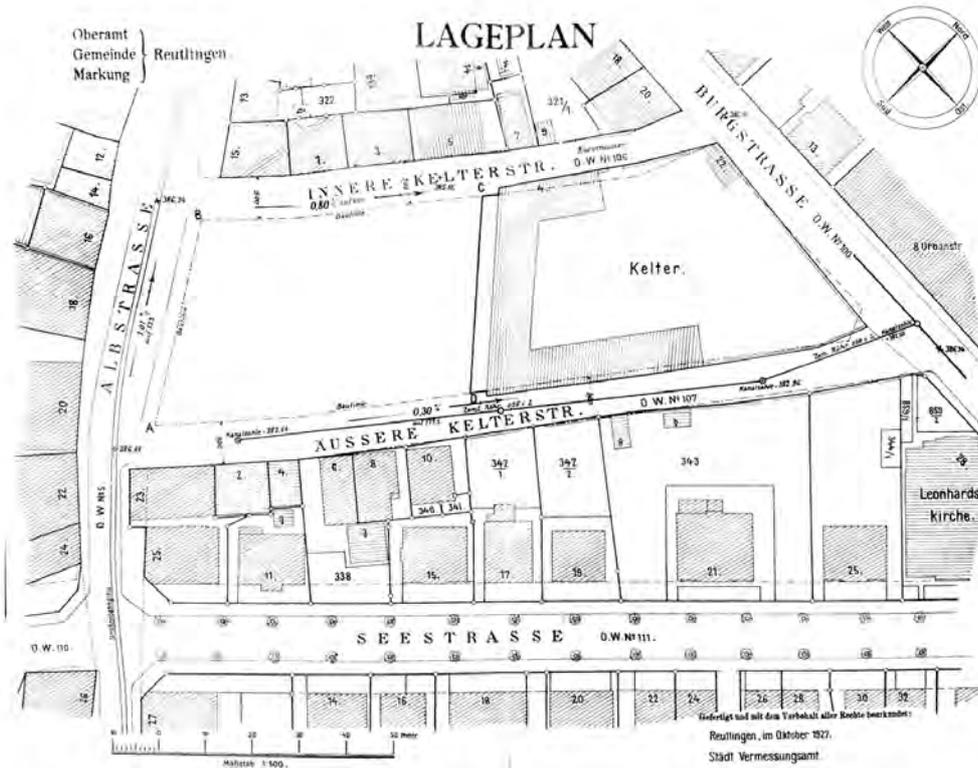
5 Lageplan mit Bauplatz für das Hallenbad Reutlingen, 1927 (Stadtarchiv Reutlingen, Hochbauamt Bestand 864)
